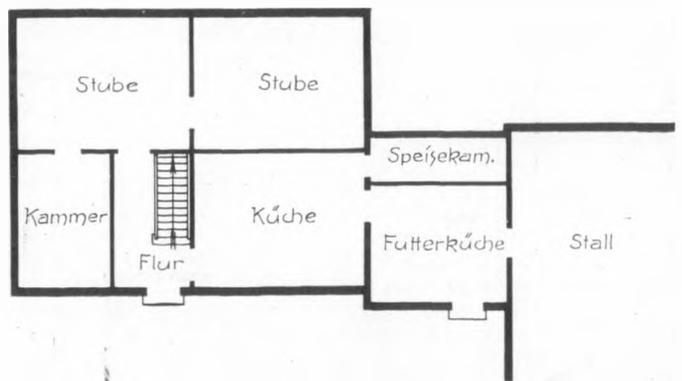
Wohnhaus mit 4 Wohnräumen im Erdgeschoß durch Futterküchenzwischenbau mit dem Stall verbunden. Ausbau von 2 Giebelzimmern im Dachgeschoß möglich, Erweiterung durch Anbau nicht möglich.
